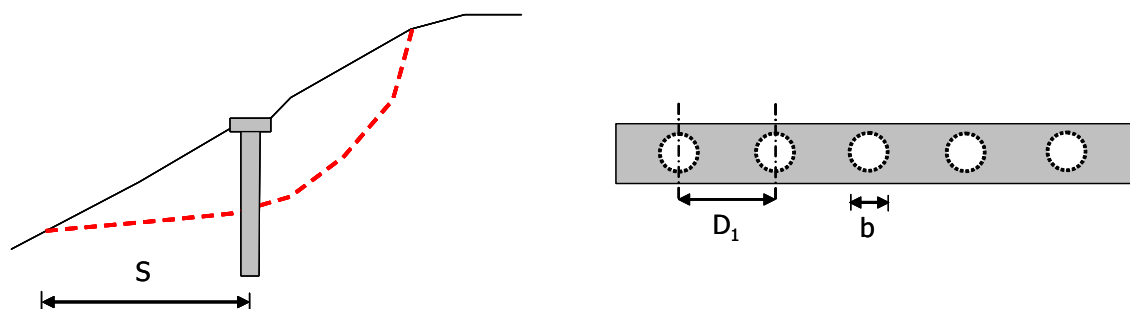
Parametri geometrici di una palificata: a sinistra vista in sezione a destra vista in pianta. S = distanza dal piede della frana; D_1 interdistanza tra i pali; b diametro dei pali –
